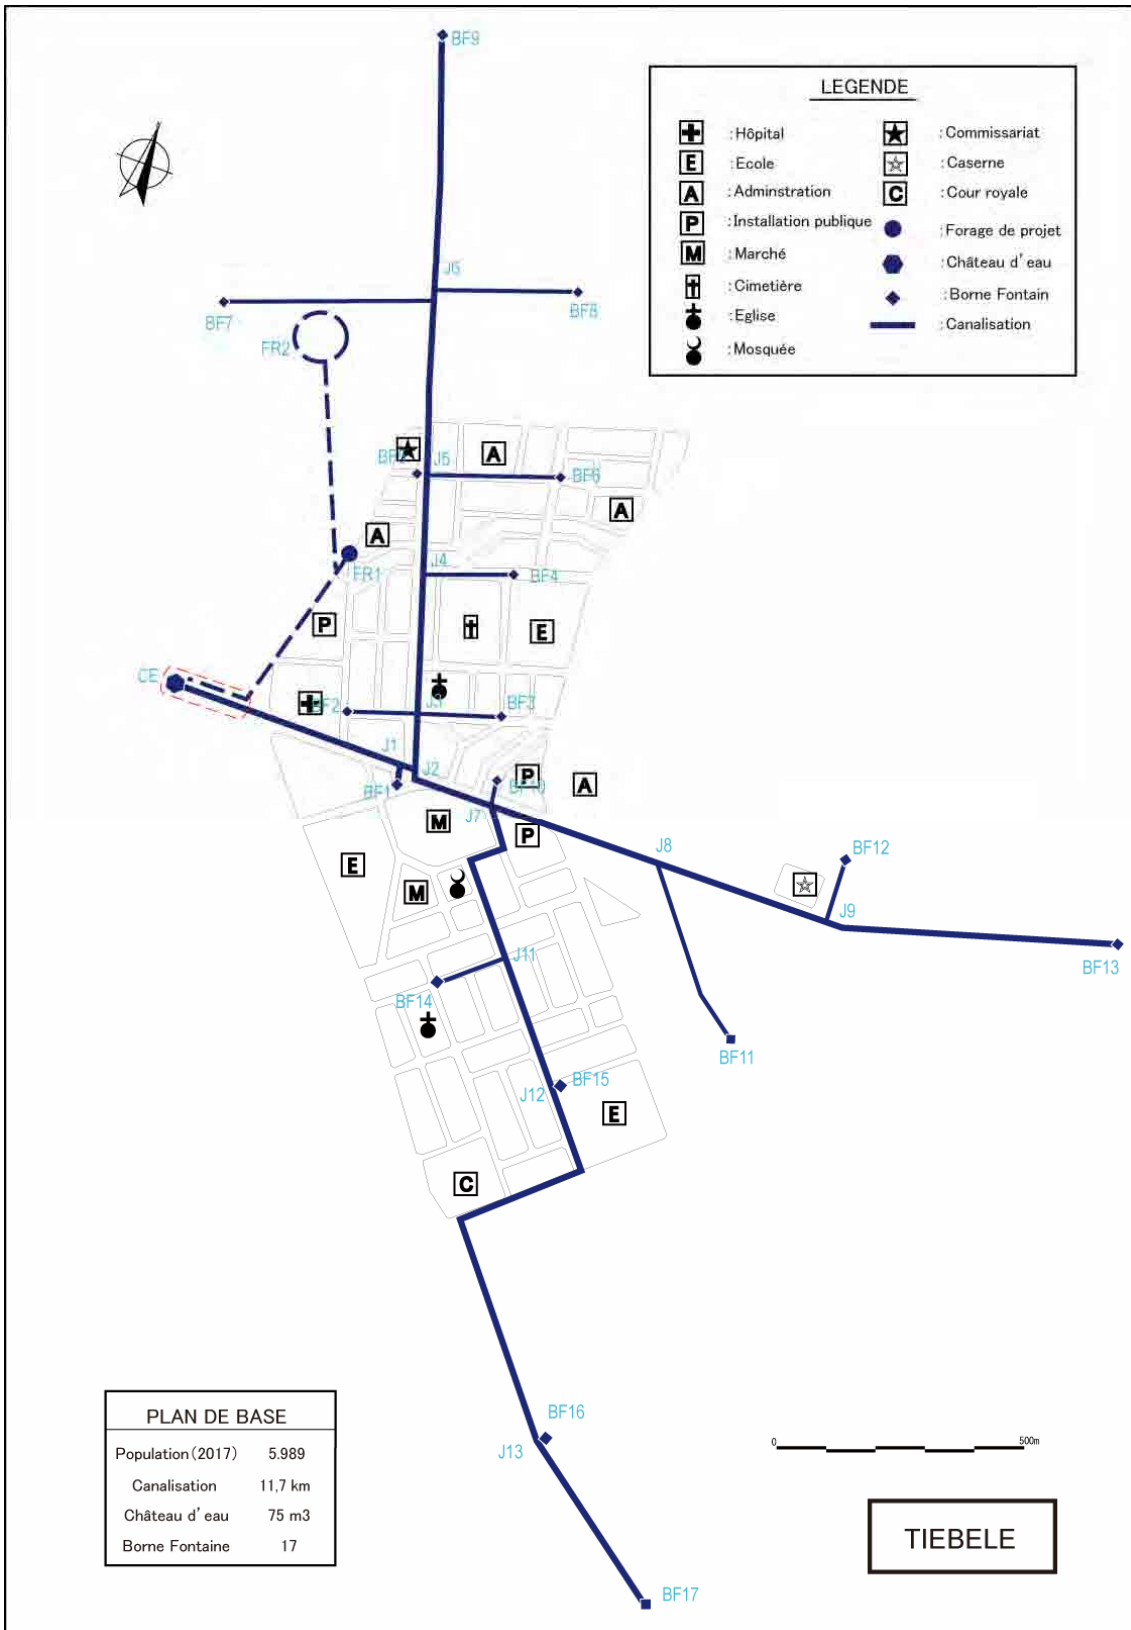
Plan planimétrique de l'AEPS à Tiébéle
